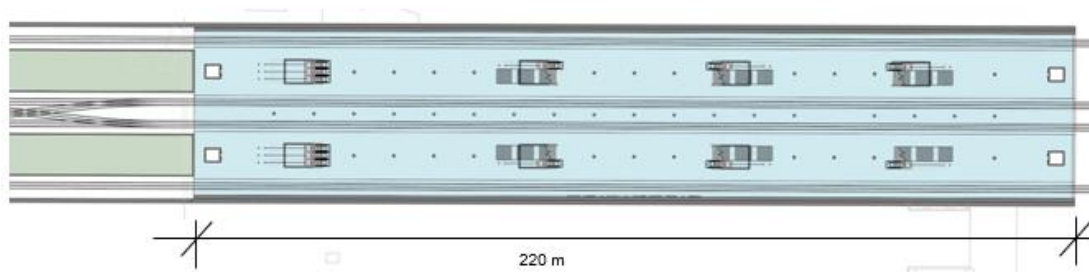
HP Altona Diebsteich Var. 1c – Grundrisse
